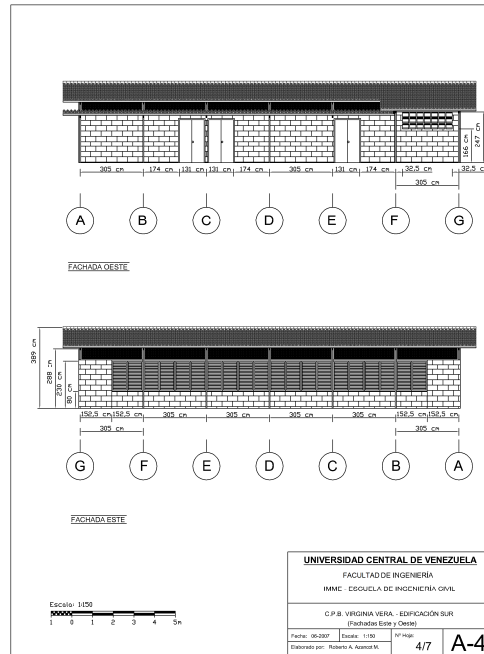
Plano A4: Plano Arquitectónico de la Fachada Este y Oeste
